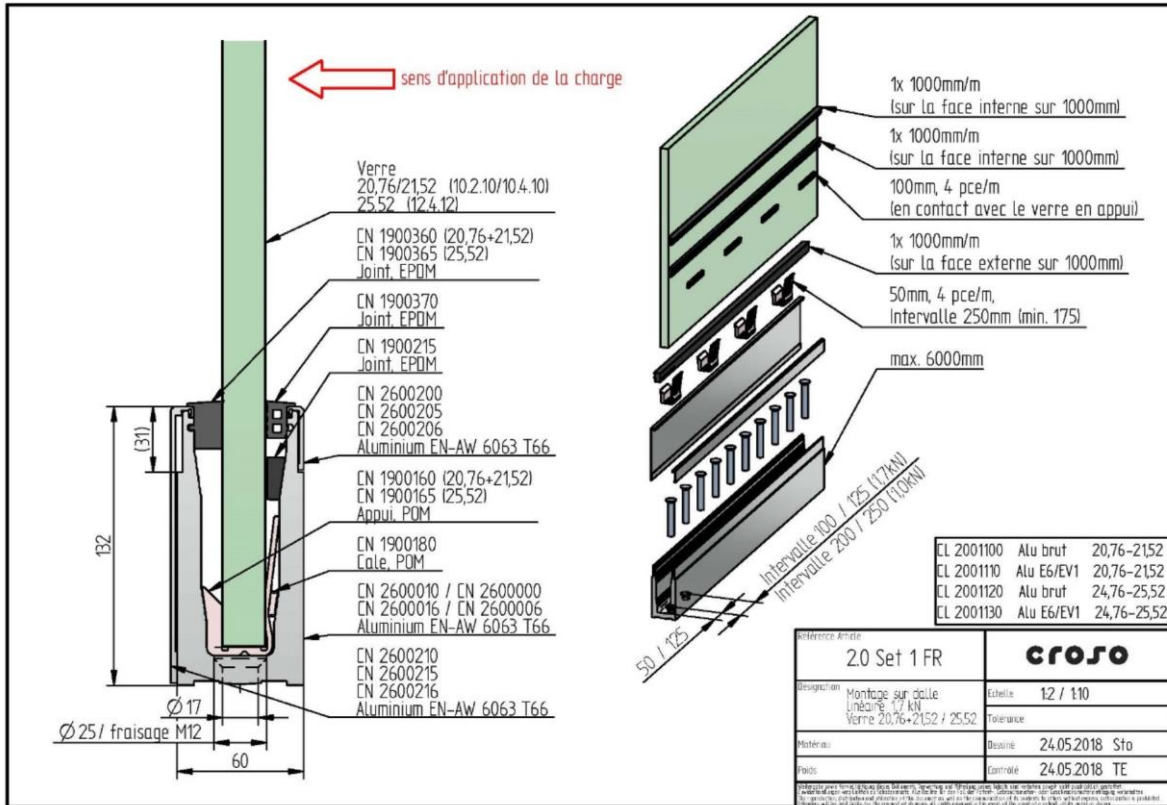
CROSILUX 2.0 - Montage sur dalle
